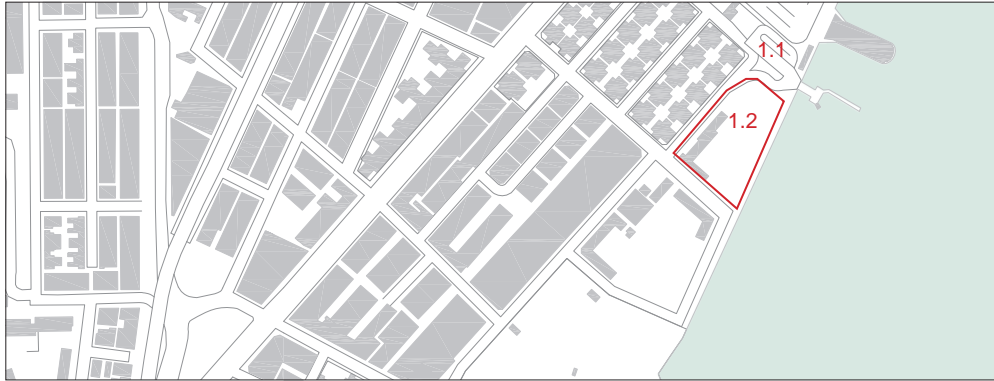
Lageplan - Grundstücksituierung im Bezirk Kowloon Bay
